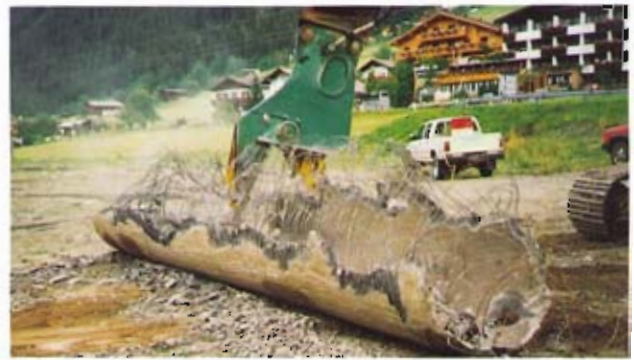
Recycling der Spannbetonrohre mit dem Concrete-Smasher
